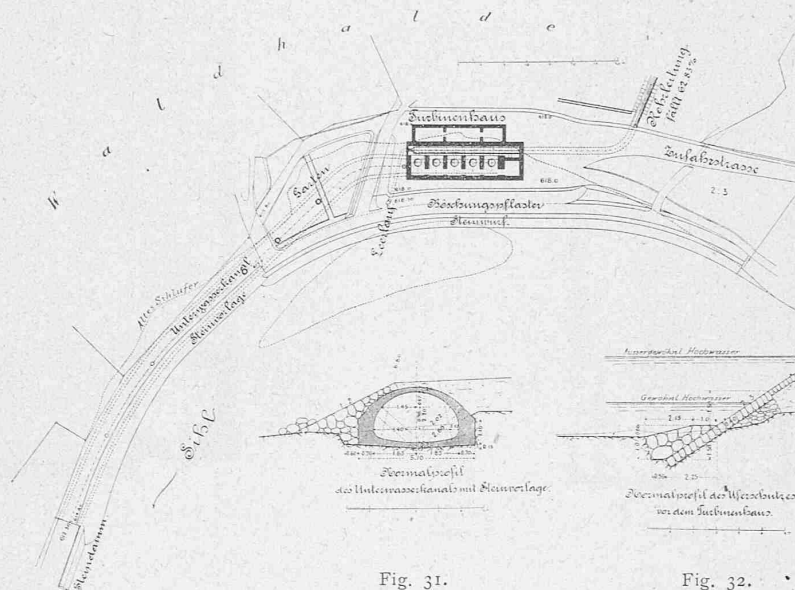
Lageplan des Turbinenhauses an der Waldhalde. Masstab 1 : 1500.
